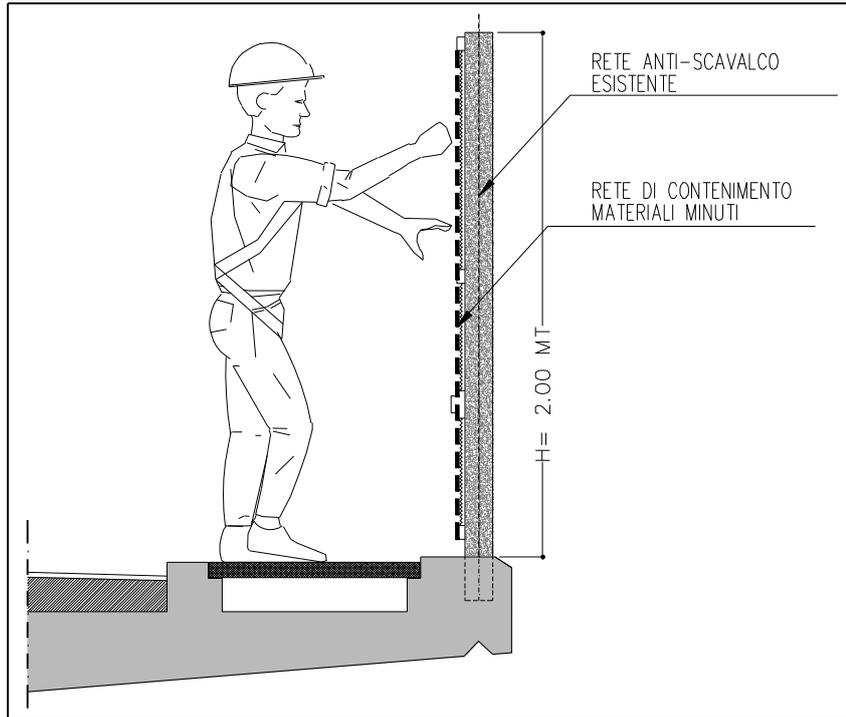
B – Schema Predisposizione Parapetto Provvisorio.
